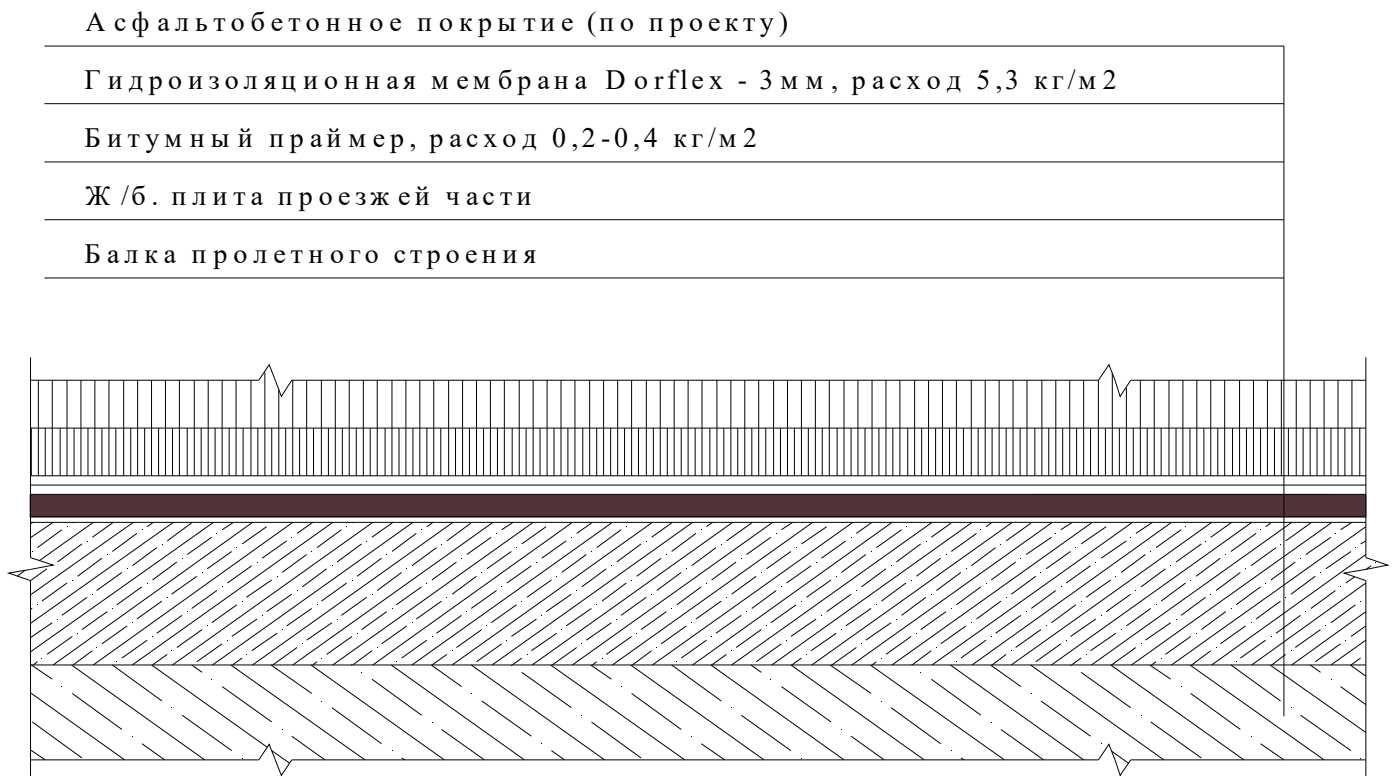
Гидроизоляция железобетонной плиты мостового сооружения.
